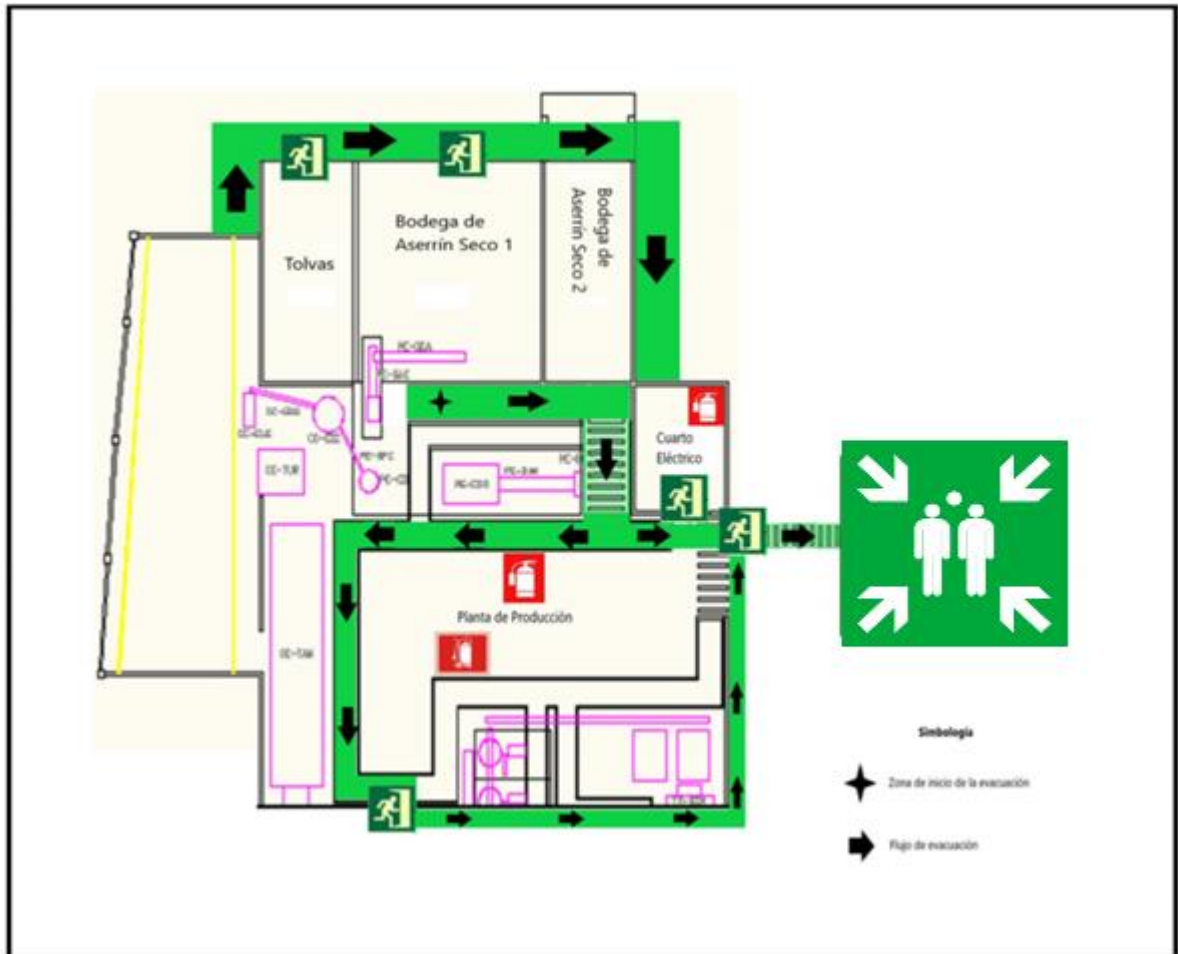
Distribución de la señalización de salvamento en la planta de producción
